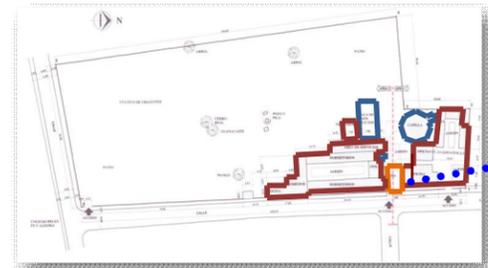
Planta de conjunto Hogar Santa Lucía./ Fuente: Propia
